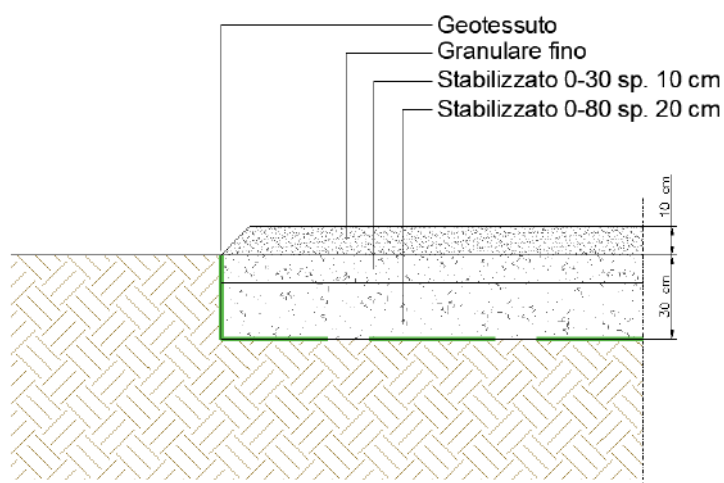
Sezione tipo viabilità interna all'impianto e piazzali
